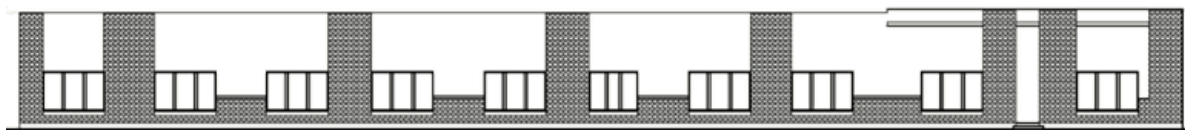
Vista de la fachada actual orientación Sur. Calle Ignacio Mejía.
